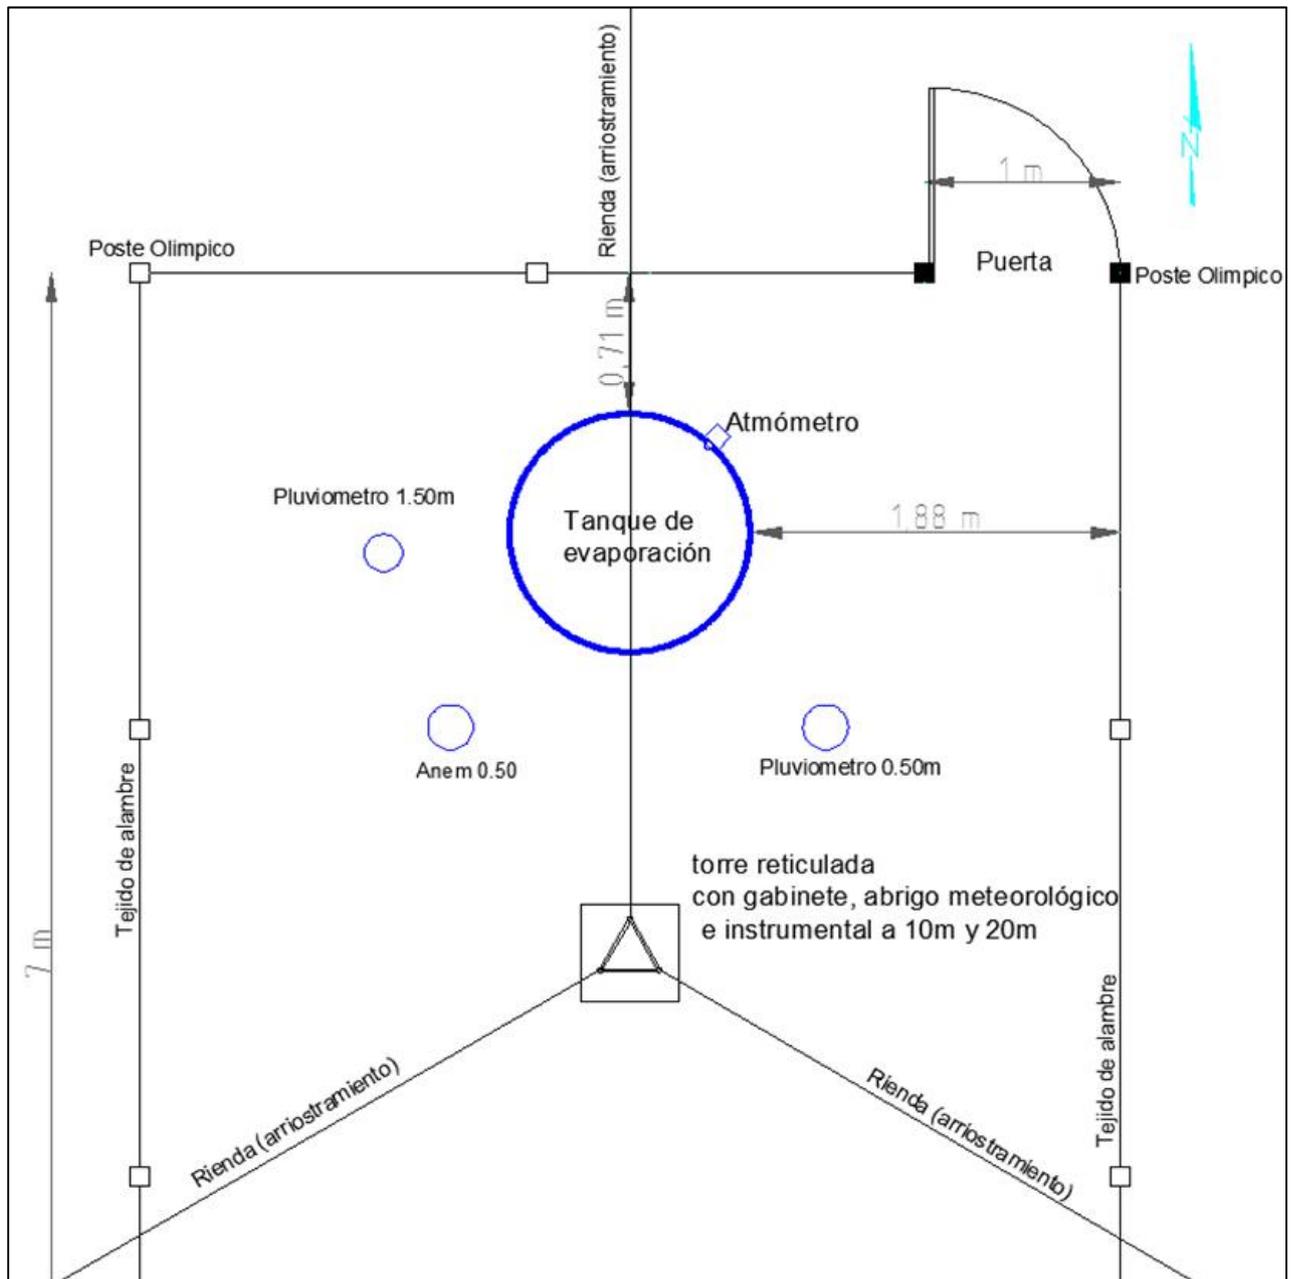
Croquis de la Planta del Cerco Meteorológico
